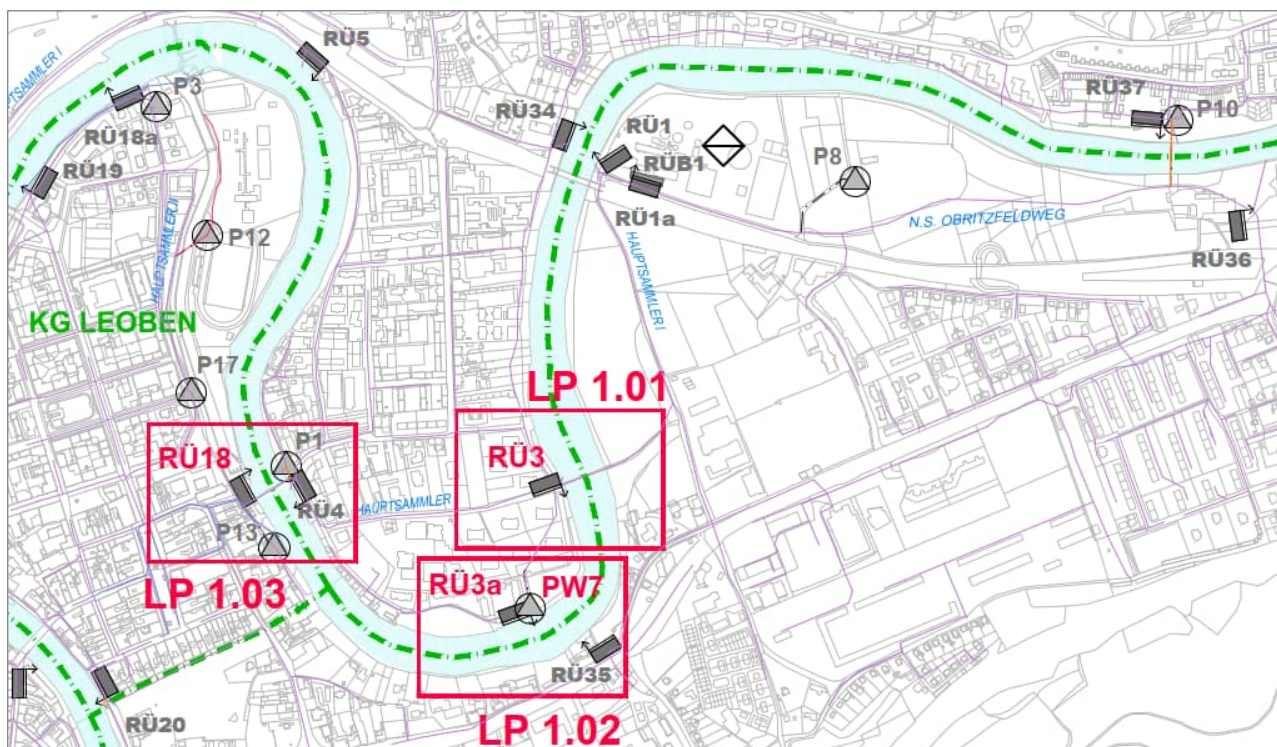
Lageplan der geplanten Umbaumaßnahmen an den Regenentlastungen (Lengyel ZT GmbH 2023)
